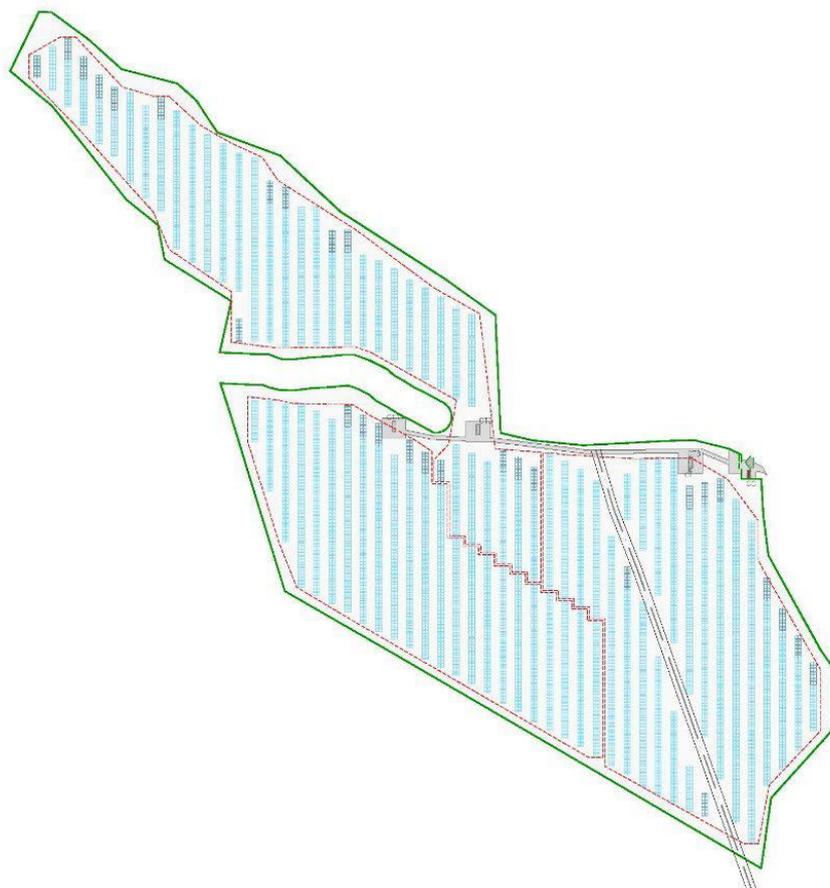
Planimetria Generale di Impianto (S.I.A.)
